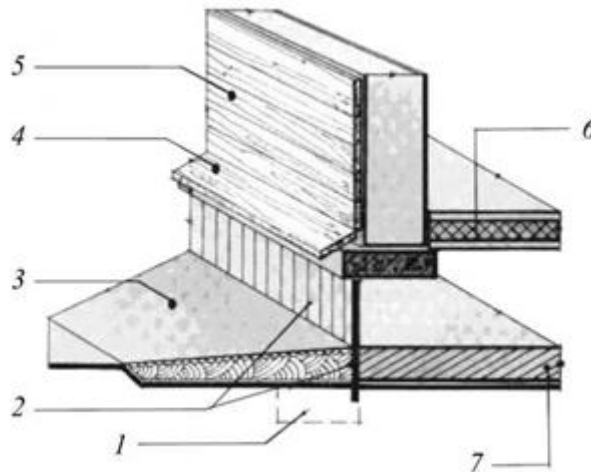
Приклад конструкції фундаменту із забиранням:
